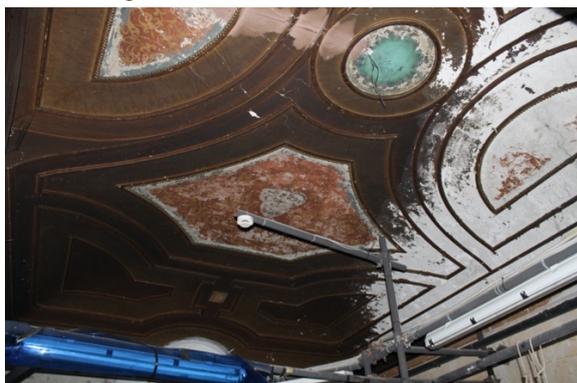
soffitto affrescato del Palco Reale del piano superiore
